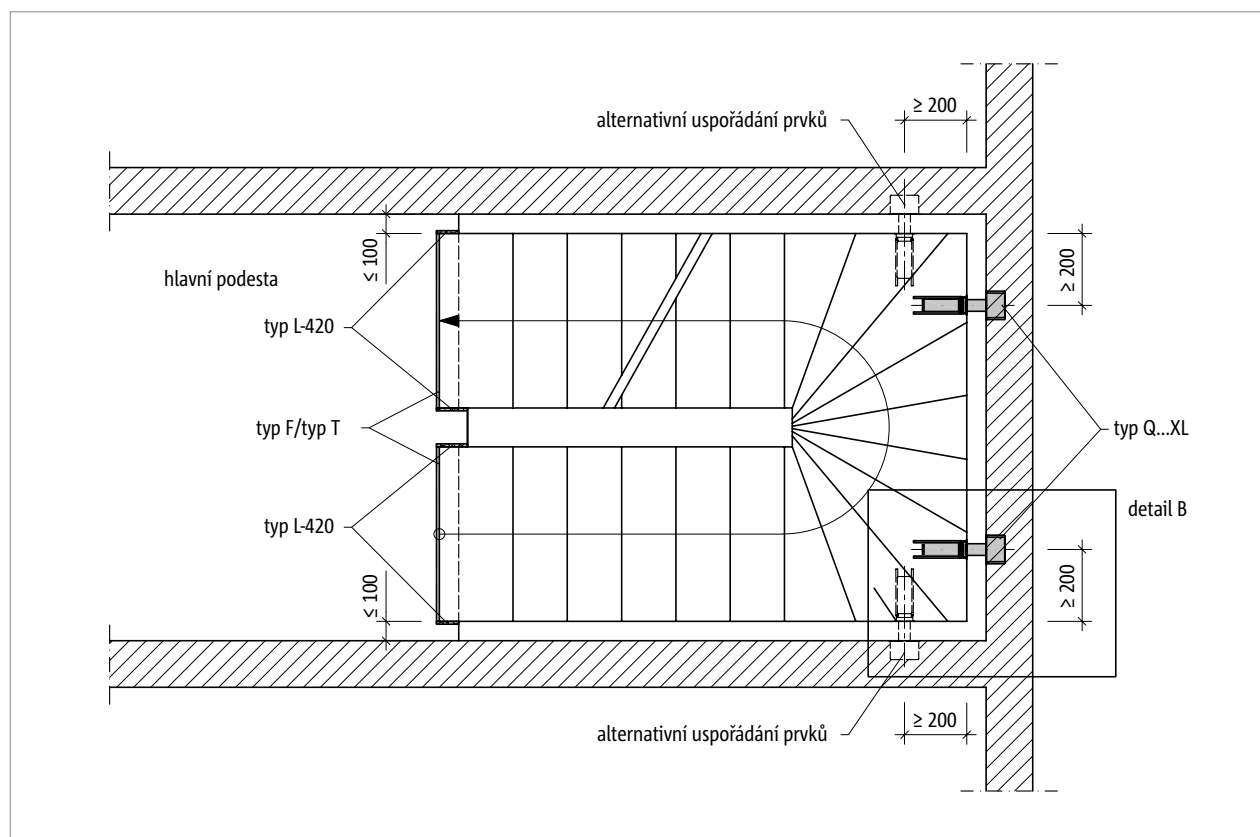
Schöck Tronsole® typ Q: Půdorysné uspořádání prvků při užití spárových desek Tronsole® typ L
